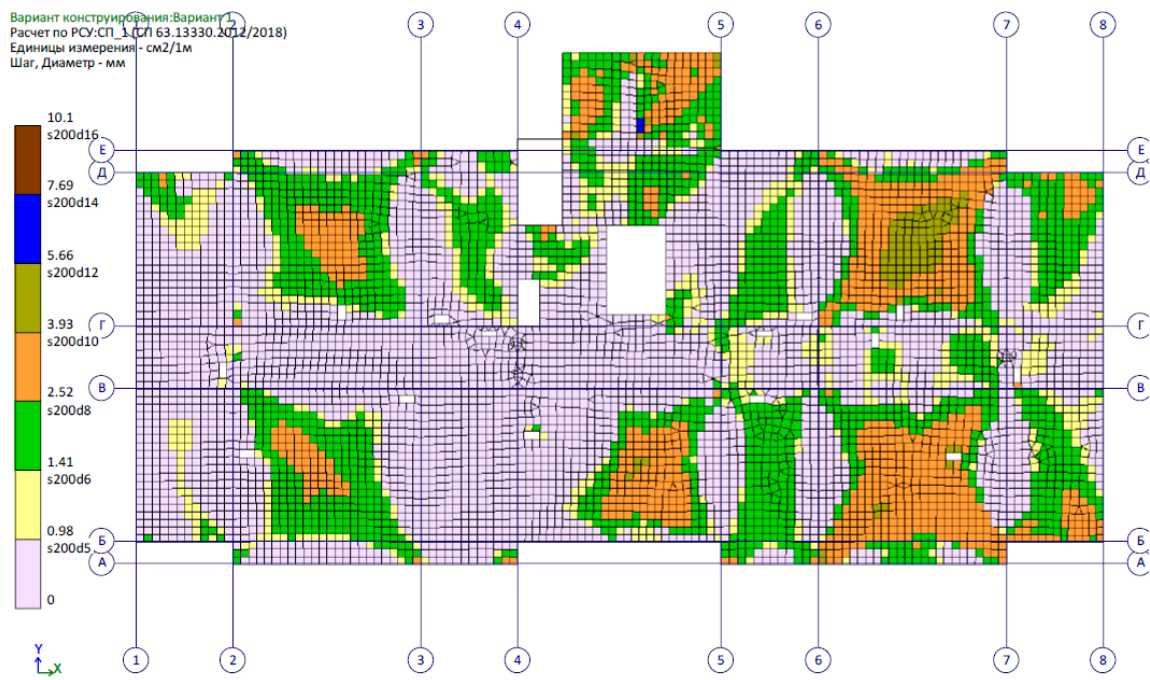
Площадь полной арматуры на 1пм по оси X у нижней грани ПЛИТЫ
